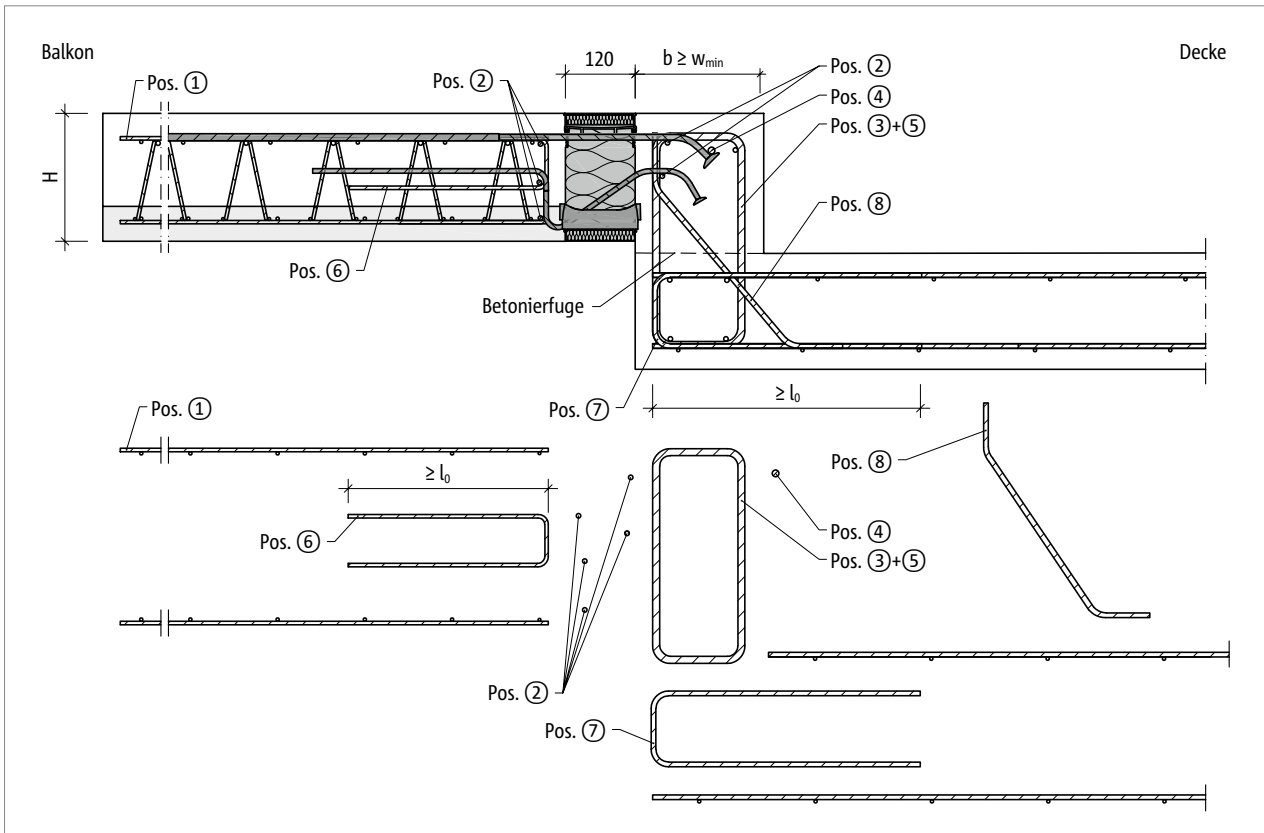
Schöck Isokorb® XT Typ KL-O-F: Bauseitige Bewehrung für Balkon mit Höhenversatz nach oben
